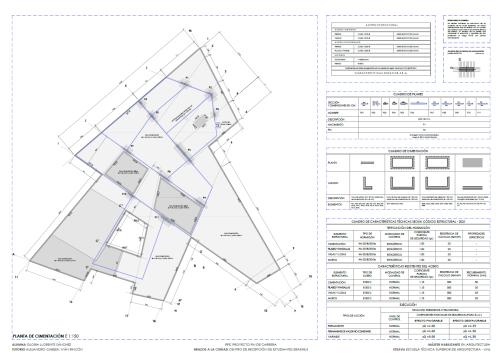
Lámina estructura. Planta de cimentación. Fuente: Elaboración propia
